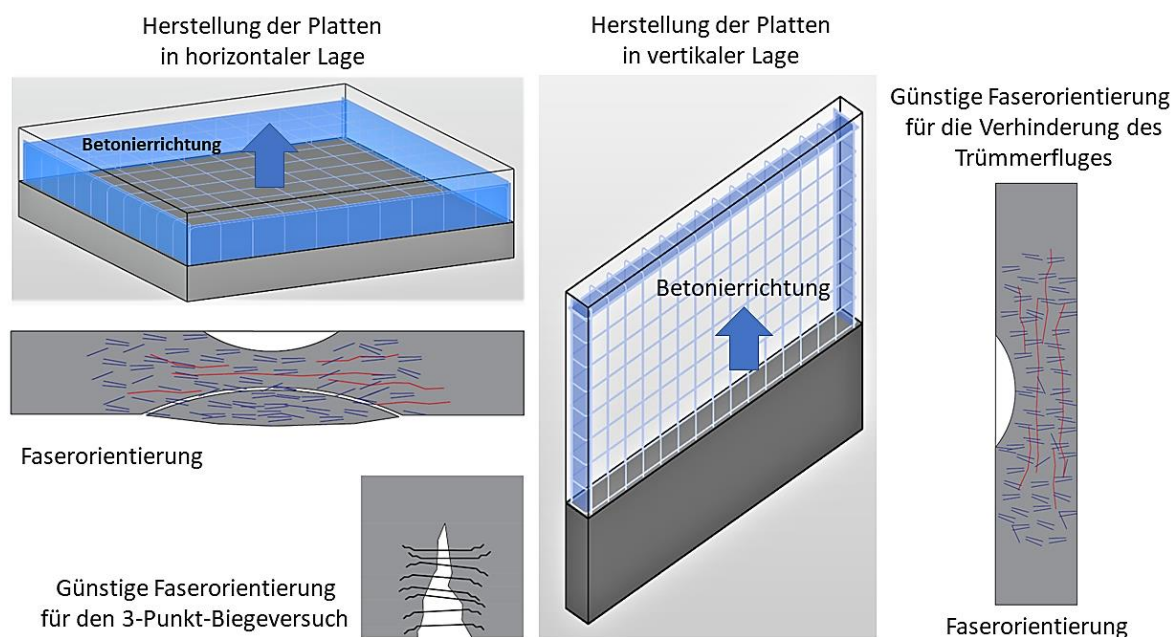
Faserorientierung durch Betonierrichtung.
